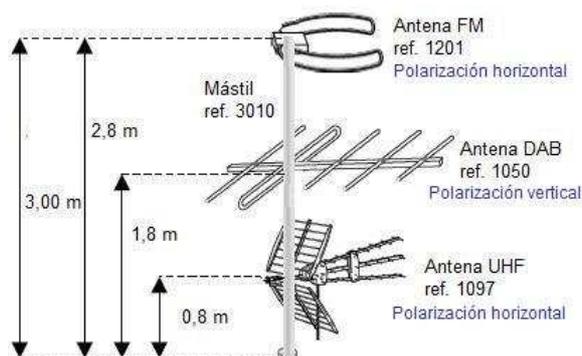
Esquema de los elementos captación de RTV terrestre
